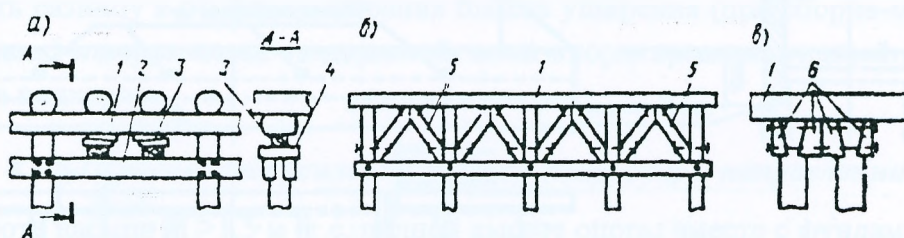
Усиление насадок: 1 – насадка; 2 – обвязка; 3 – клинья; 4 – брус; 5 – дополнительные подкосы; 6 – коротыши.
